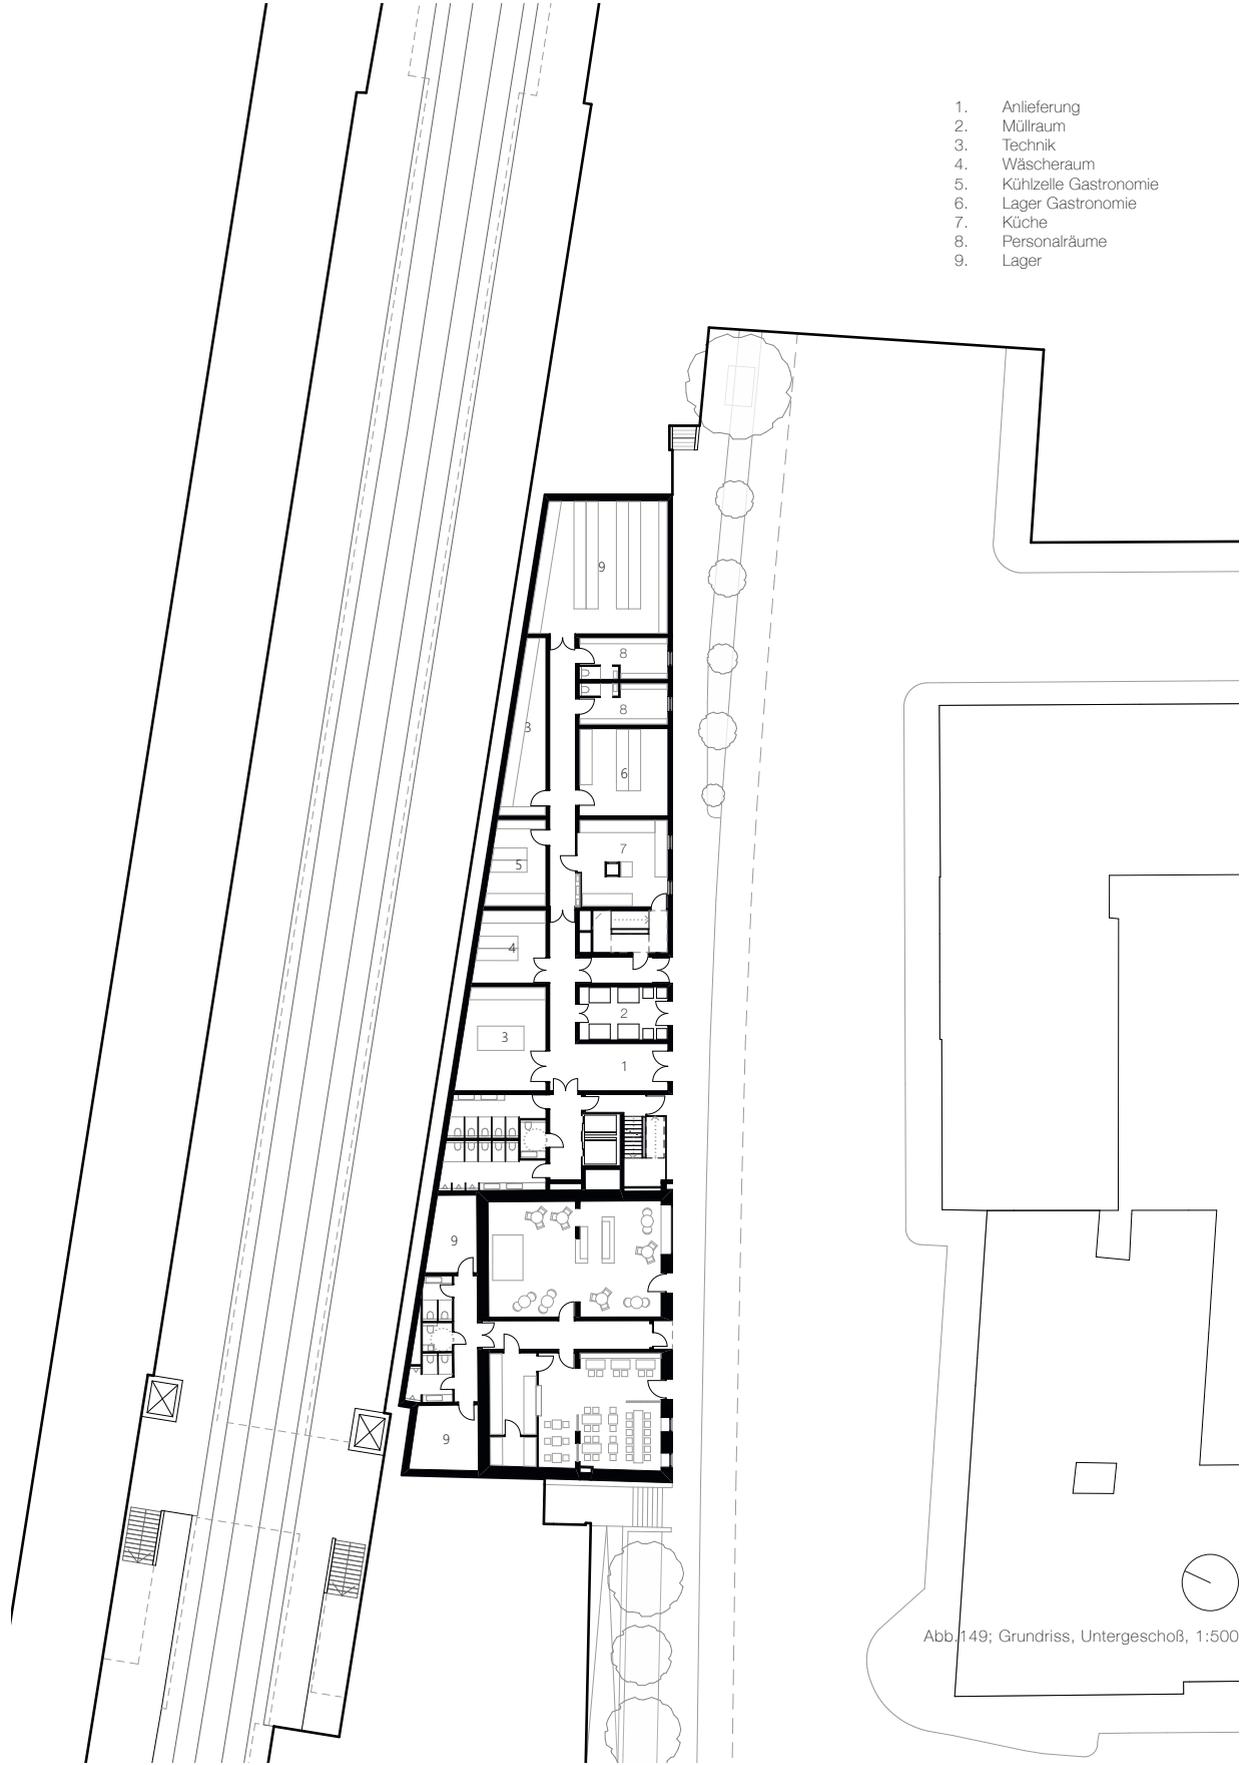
; Grundriss, Untergeschoß, 1:500
